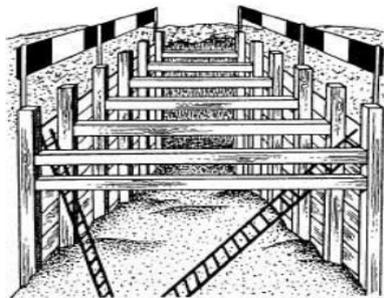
Barreras a ambos lados de una zanja, para impedir que los trabajadores caigan dentro de ella.
